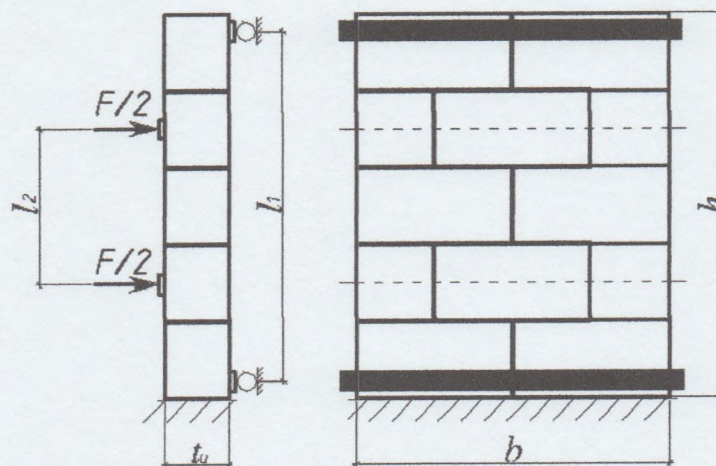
Схема испытаний кладок на изгиб по неперевязанному сечению
